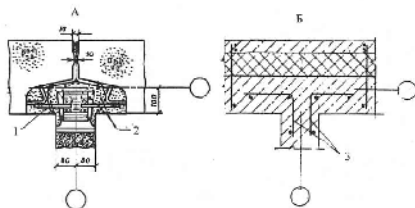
Связи между наружными и внутренними стенами. А – в панельных зданиях, Б – в монолитных: 1 – сварные стальные связи; 2 – шпунцовые бетонные связи по протяженности стыка; 3 – пространственные арматурные каркасы
